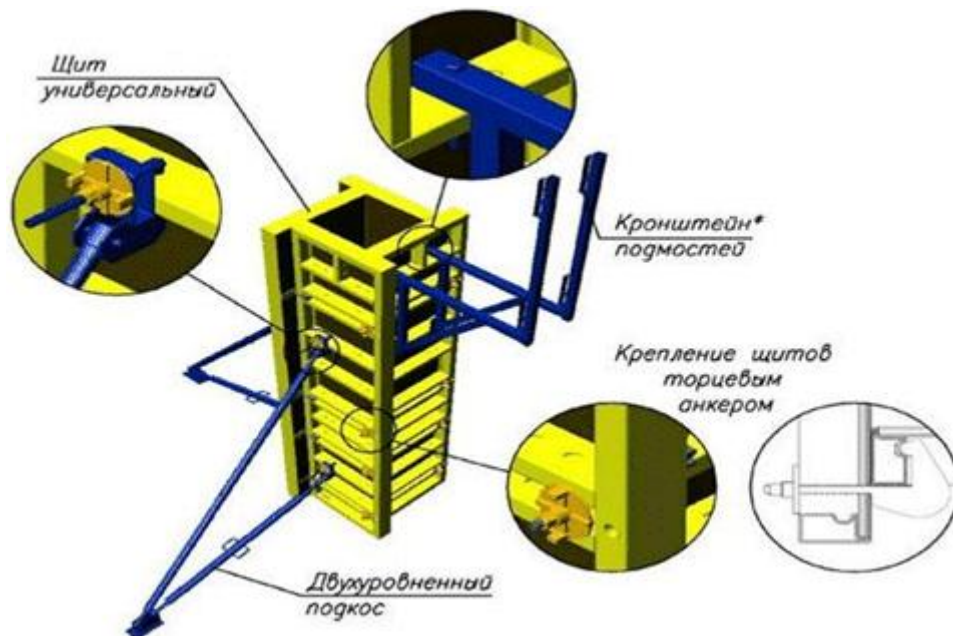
Опалубка для колонн: щит, анкер, подкос
